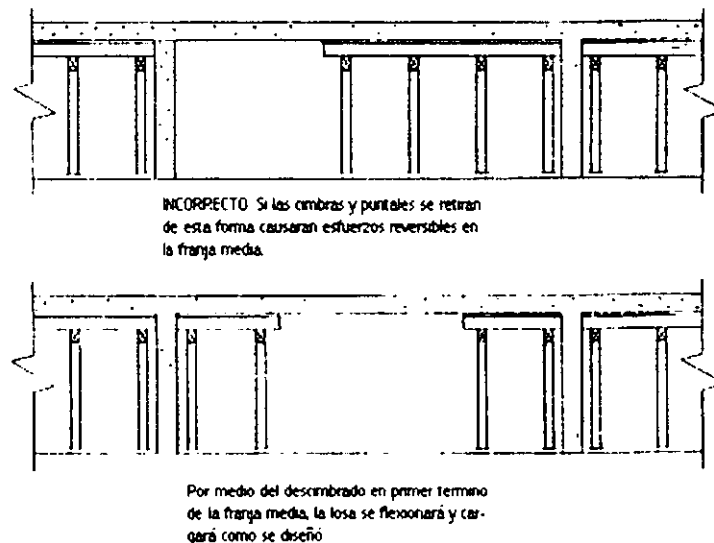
Secuencia del descimbrado para losas en dos sentidos.
